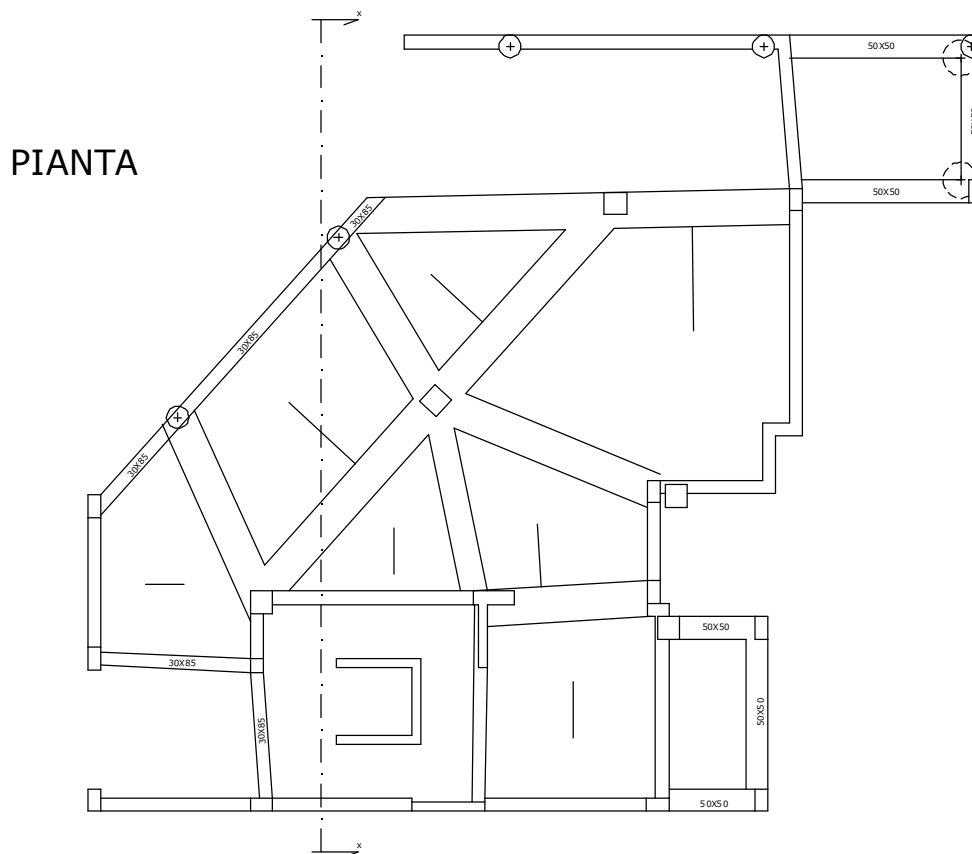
pianta delle fondazioni dell'edificio (Castellanza, 2010)
